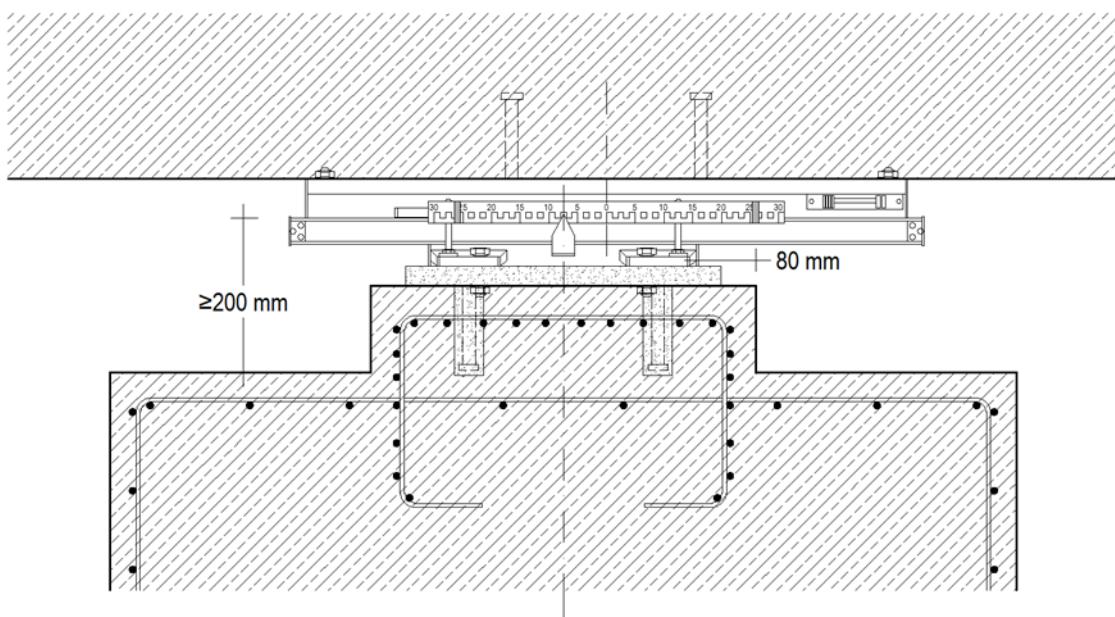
Shema delovnega prostora pod dilatirano prekladno konstrukcijo na vrhu stebra z ležišči na betonskih podstavkih ter z lokacijami dvigalk.
